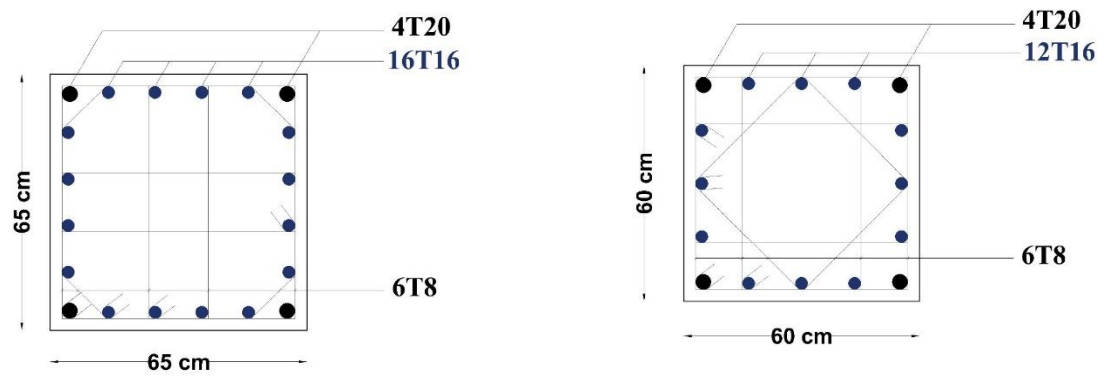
Schéma de ferrailage des poteaux (65x65) et (60x60)
